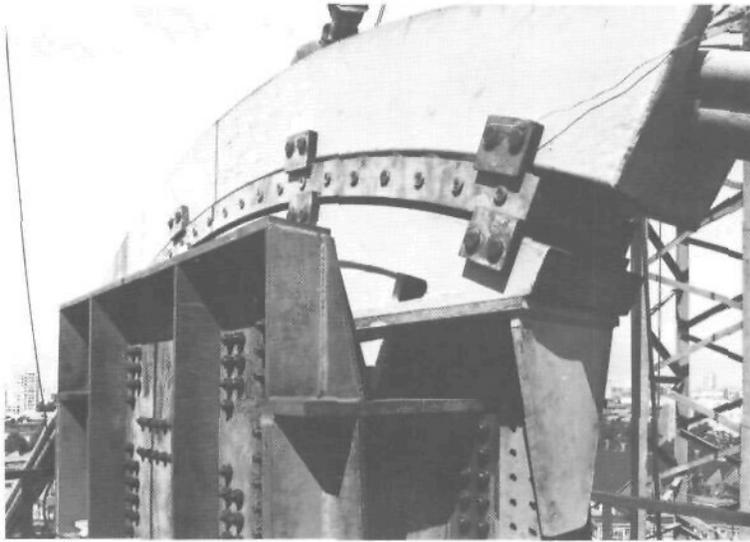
L'ouvrage est terminé par construction en encorbellement.
